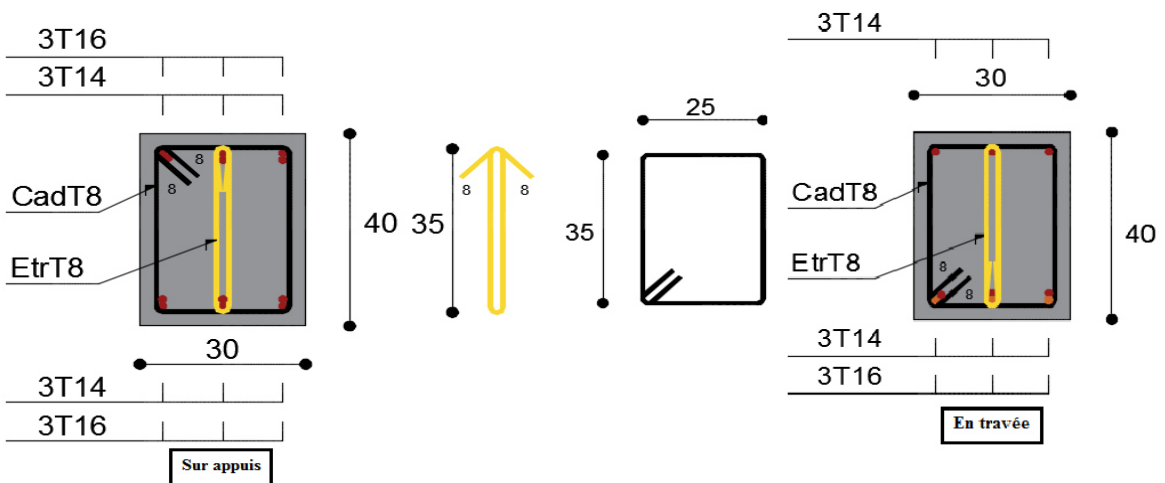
schéma de ferrailage des poutres principales en travée et en appuis bloc A et C.
